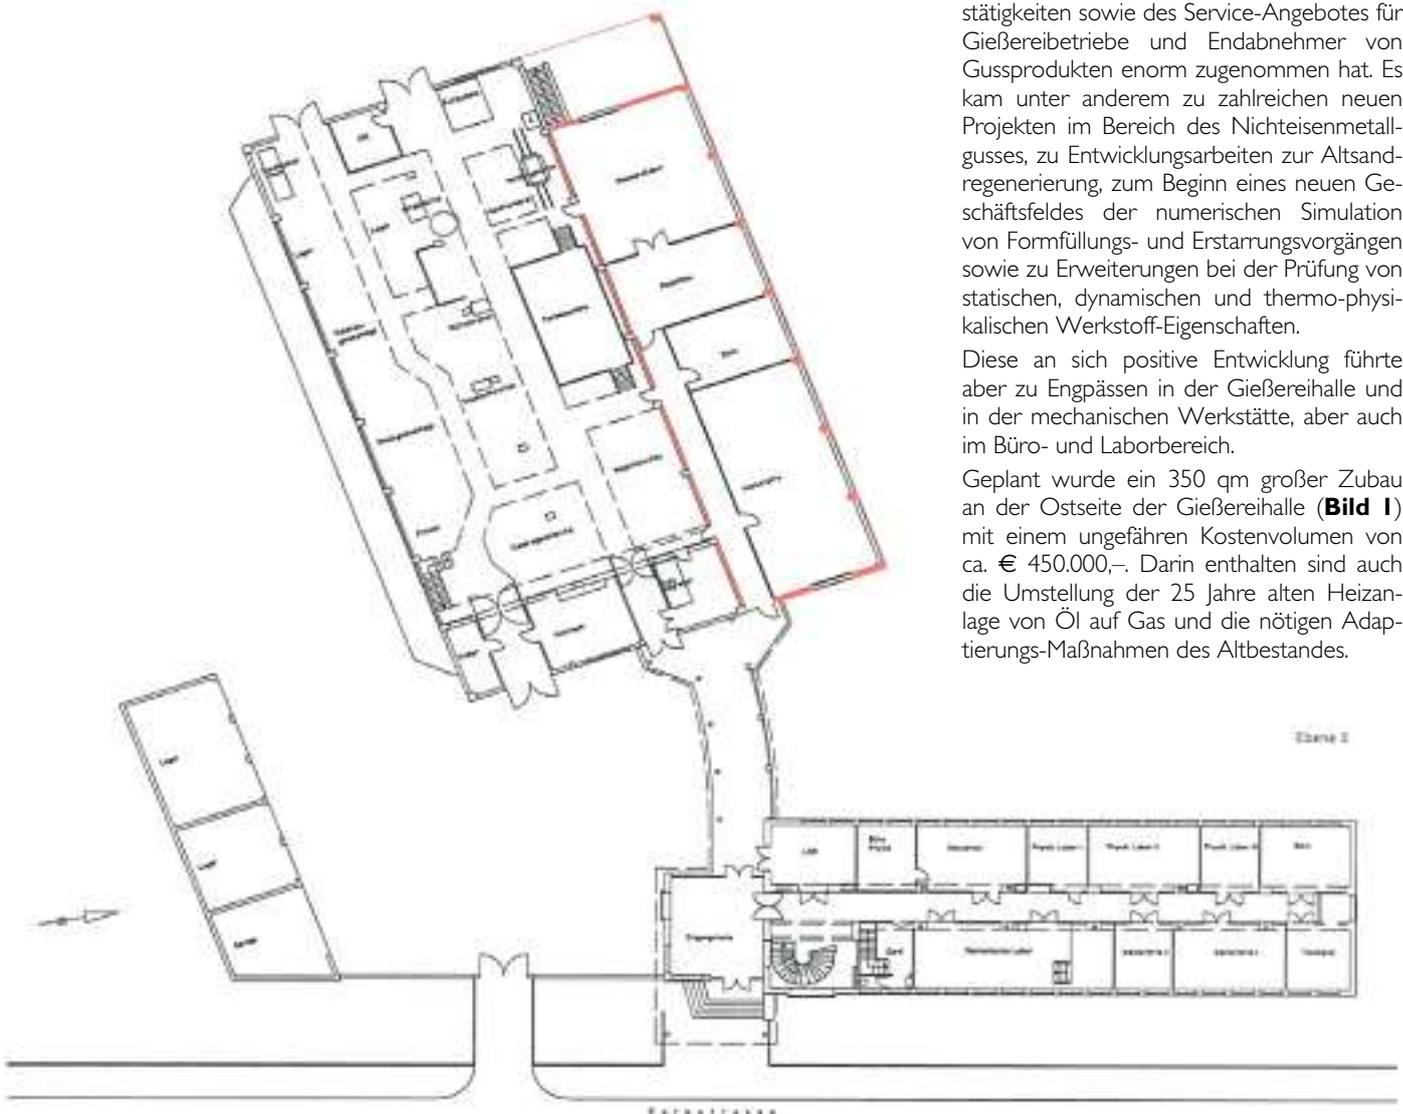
Lageplan des Österreichischen Gießerei-Institutes mit dem geplanten Erweiterungsbau
